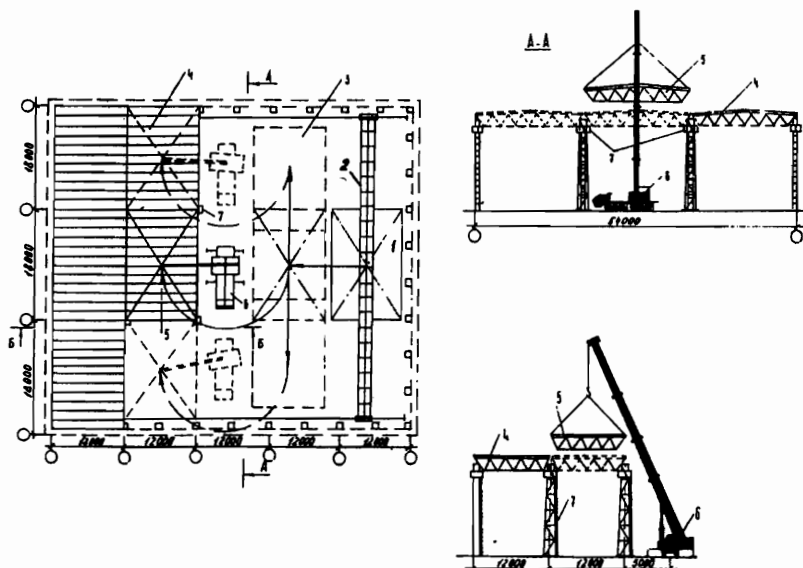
Монтаж покрытия зданий зального типа методом полунавесной сборки: 1 - сборочный стенд; 2 - козловый кран; 3 - монтажная площадка; 4 - структурный блок установленный; 5 - структурный блок монтируемый; 6 - монтажный кран; 7 - временная опора
